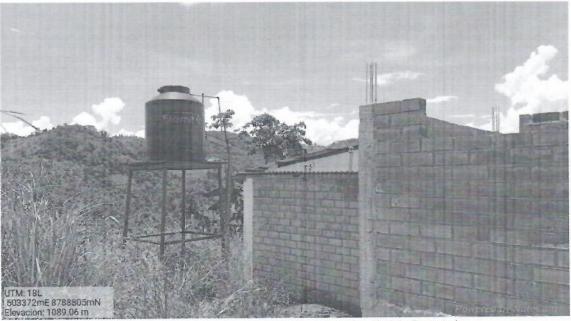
Vista del tanque elevado ubicado en la posta de salud de Pucusani.
